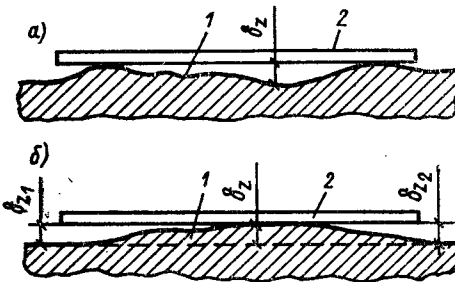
Определение непрямолинейности бетонных и железобетонных изделий
